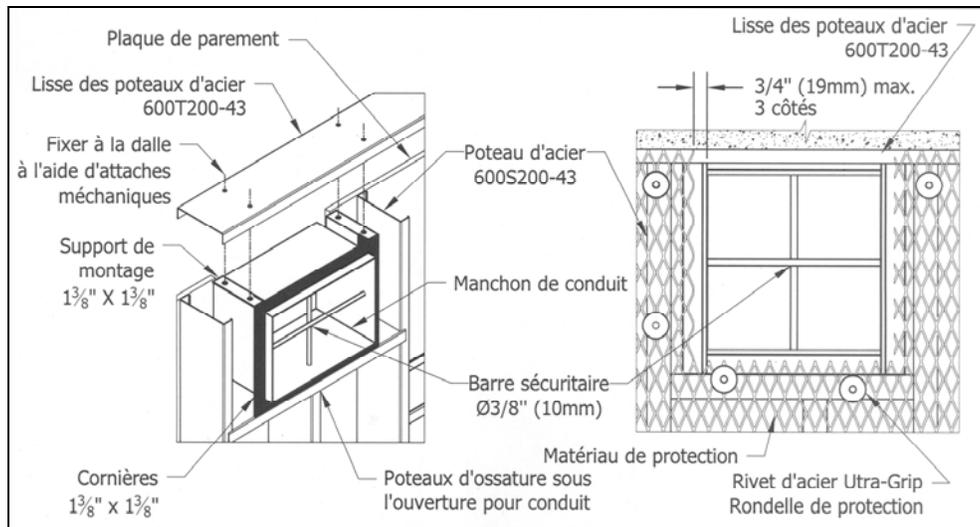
Ouverture pour conduit de ventilation monté au plafond
